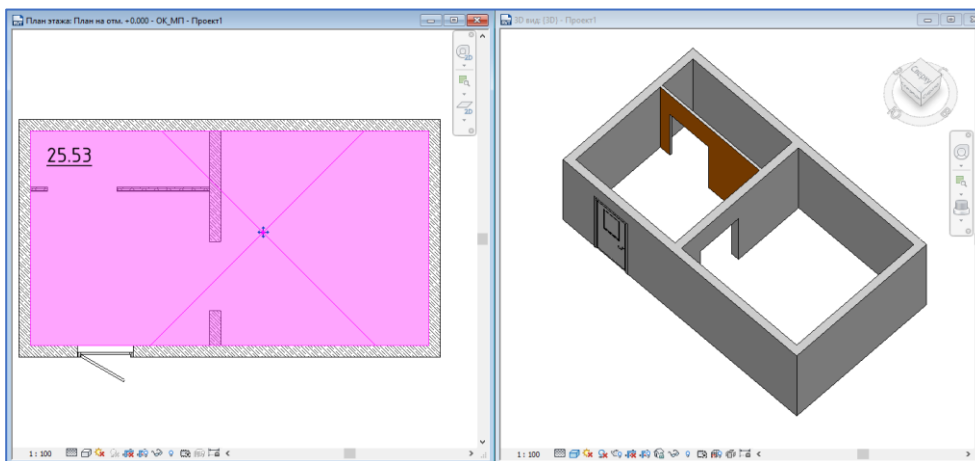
Пример размещённого помещения с неучтёнными несущими стенами / перегородками
